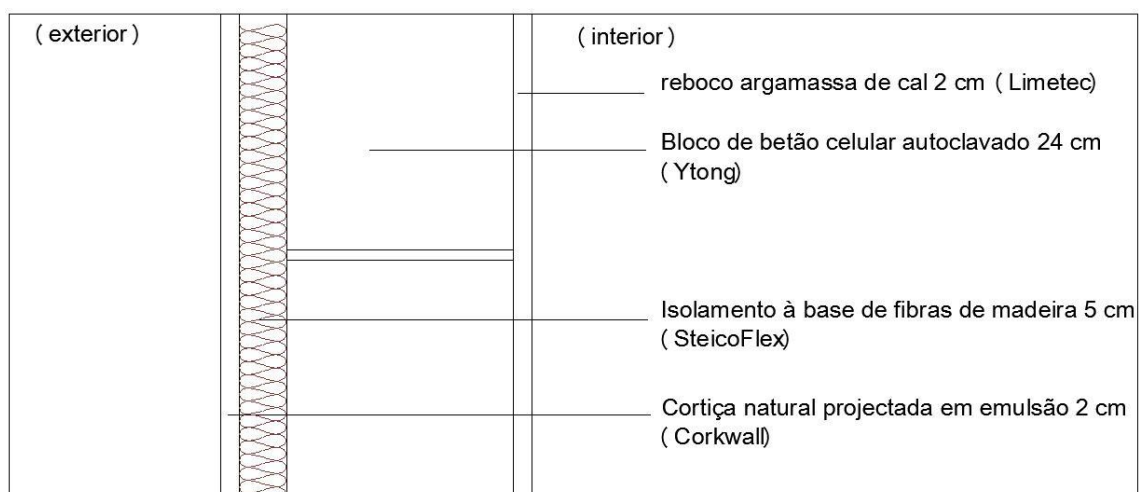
Pormenor construtivo de parede exterior proposta na solução 3
